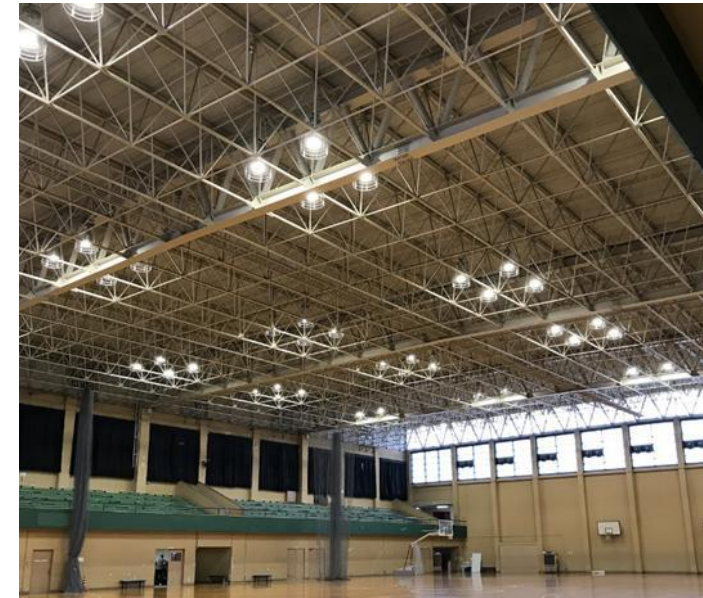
屋根面立体トラス補強前（補強水平ブレースなし）
